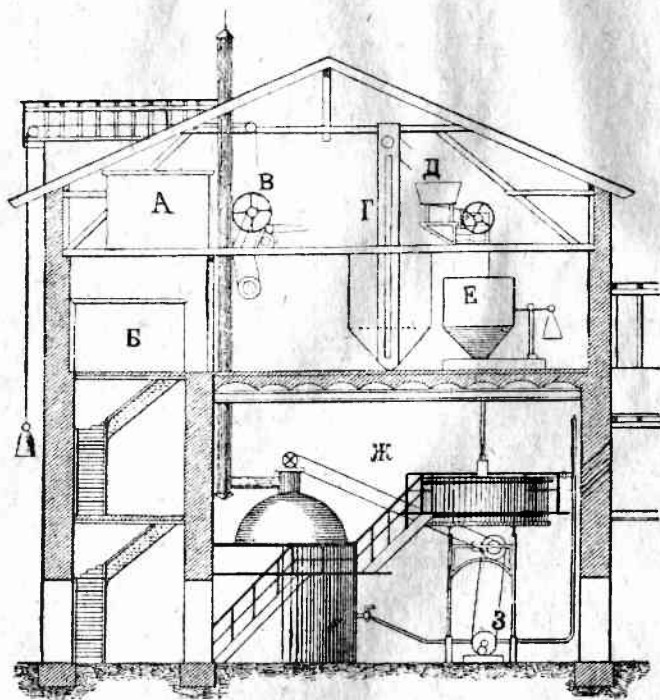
Варочное отделение с заторными чанами и с заторным котлом. А—холодный резервуар; Б—теплый резервуар; В—подъемник; Г—элеватор; Д—дробилка; Е—весы; Ж—варочный котел; З—насос.
